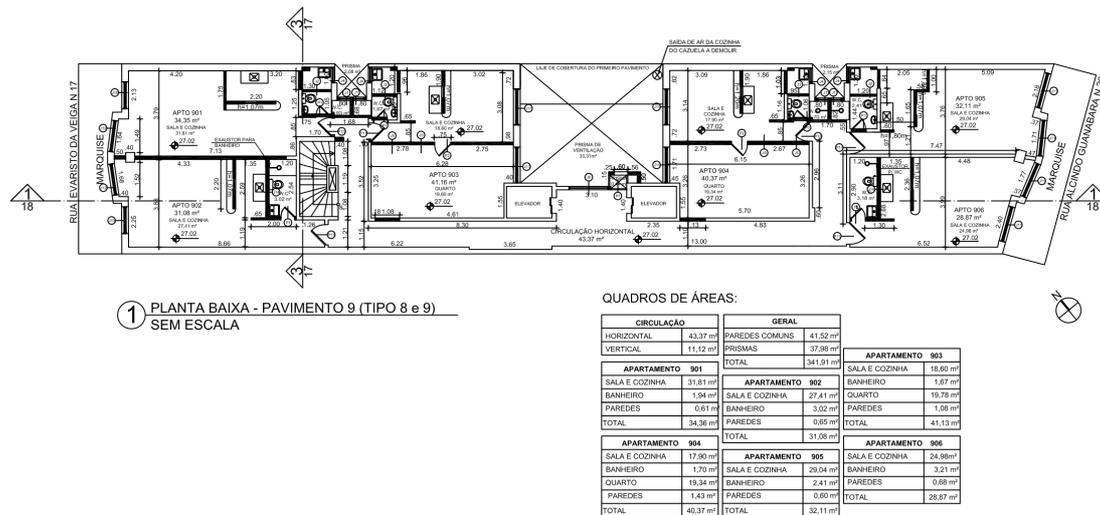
Planta do pavimento tipo. Fonte: NUNES, 2019, anexos
